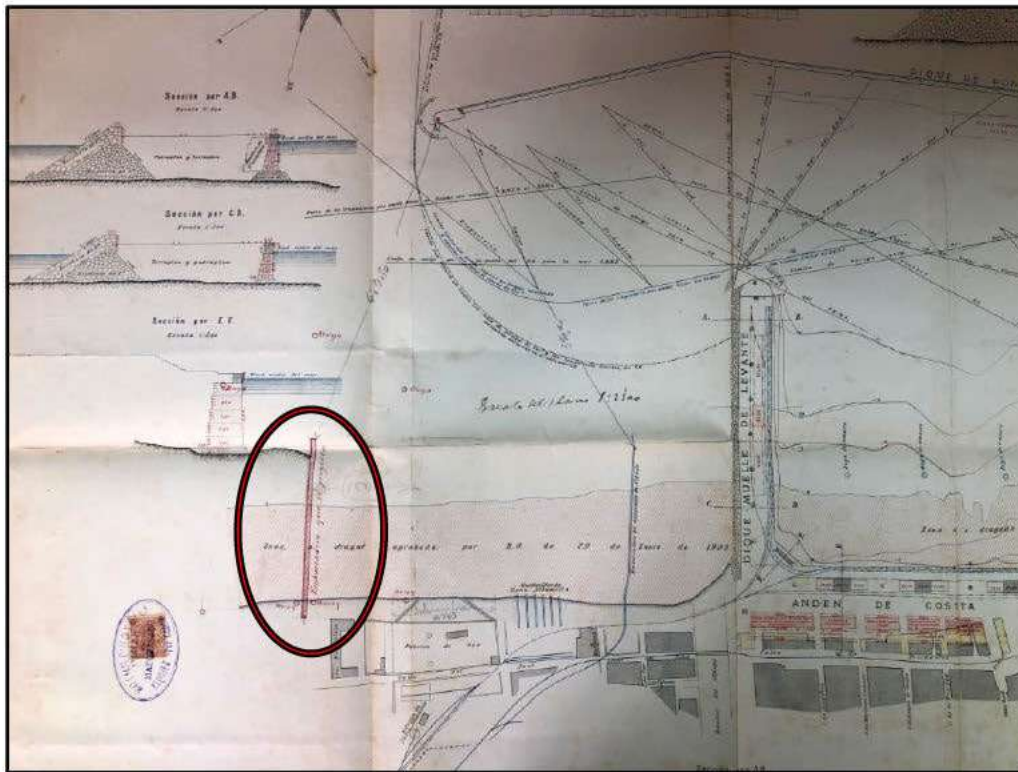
Plano de situación del futuro embarcadero de Bairds Mining, 1912. Fuente: AHPA. Signatura 1952-713.
